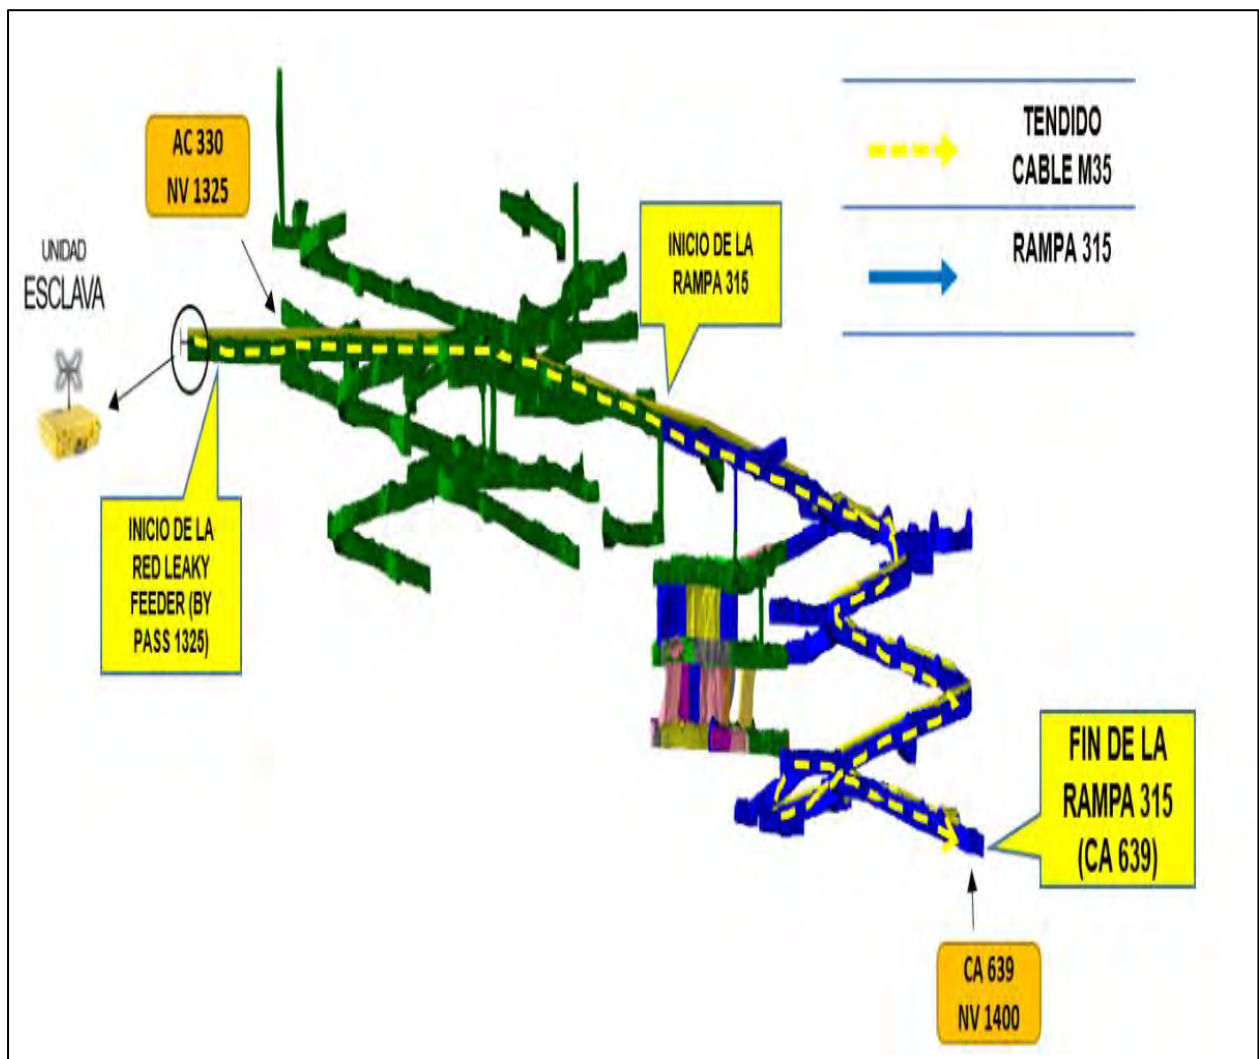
Recorrido de Cable Radiante por la Zona Salvadora.
